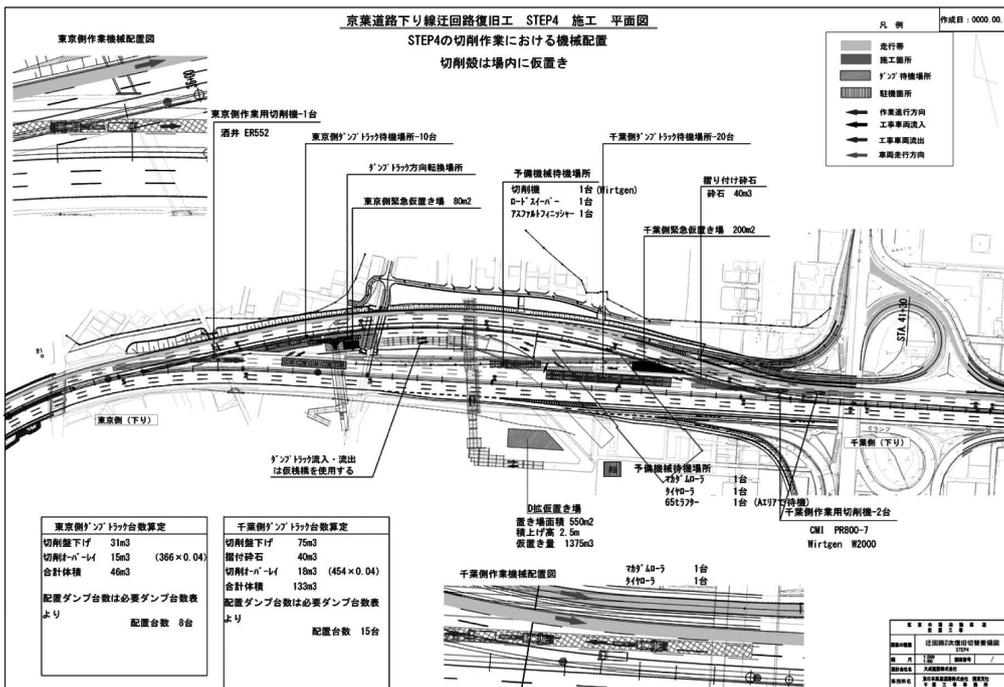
切削作業時の機械配置平面図(下り復旧, 11/5夜の例)
